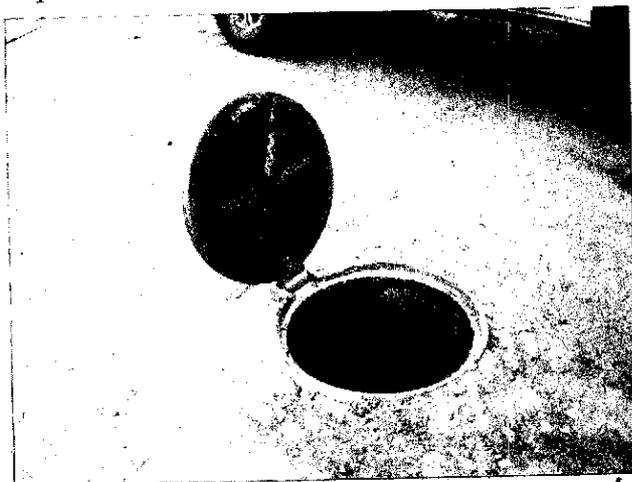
Poço de visita do trecho já instalado da rede de drenagem pluvial .
